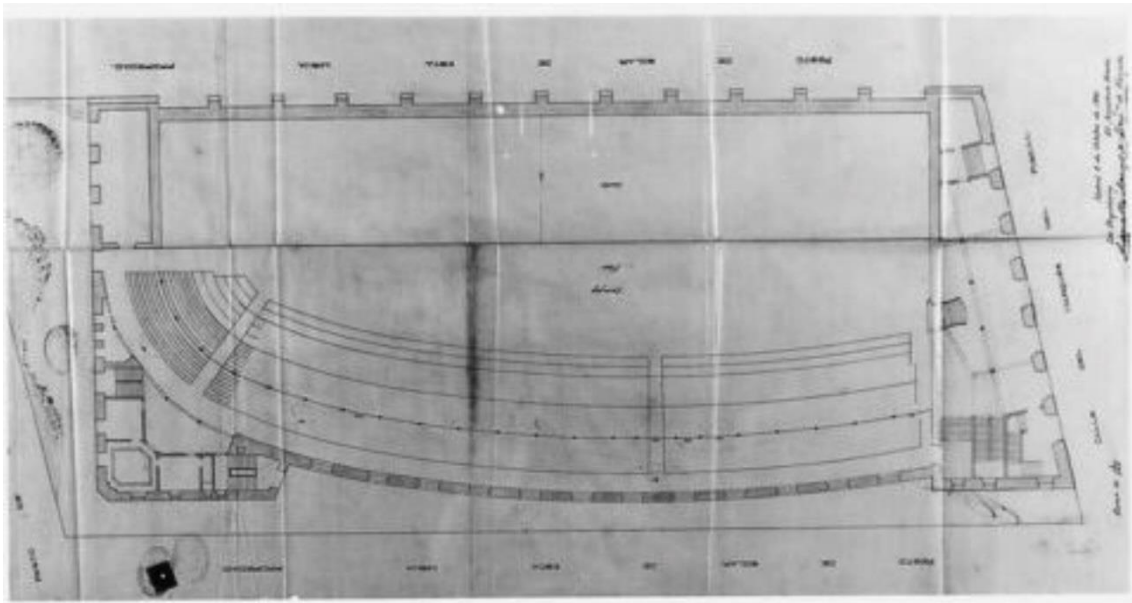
Fotografía de un plano original de la planta de acceso al frontón Beti Jai de Madrid
